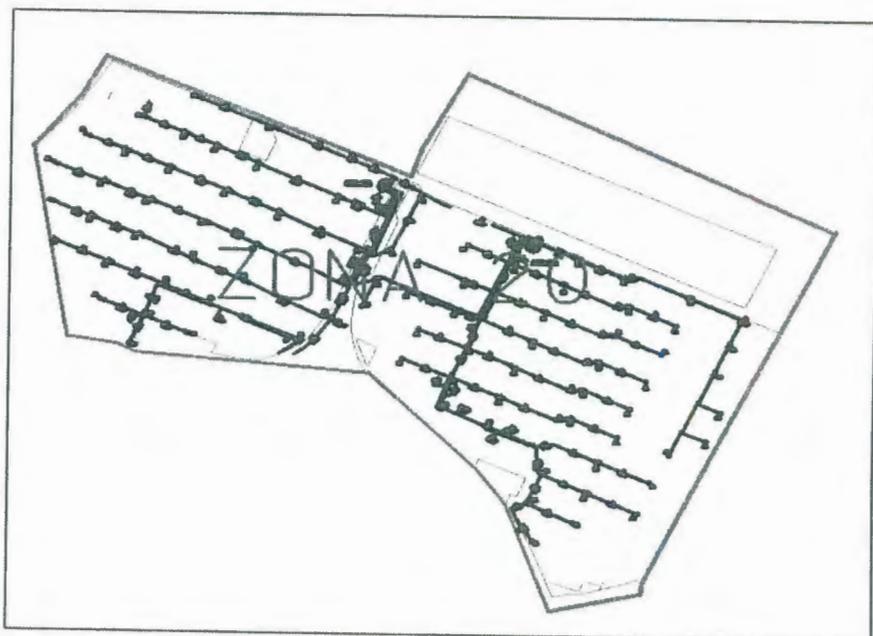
Planimetría zona 20 del sector de la vía a Daule
